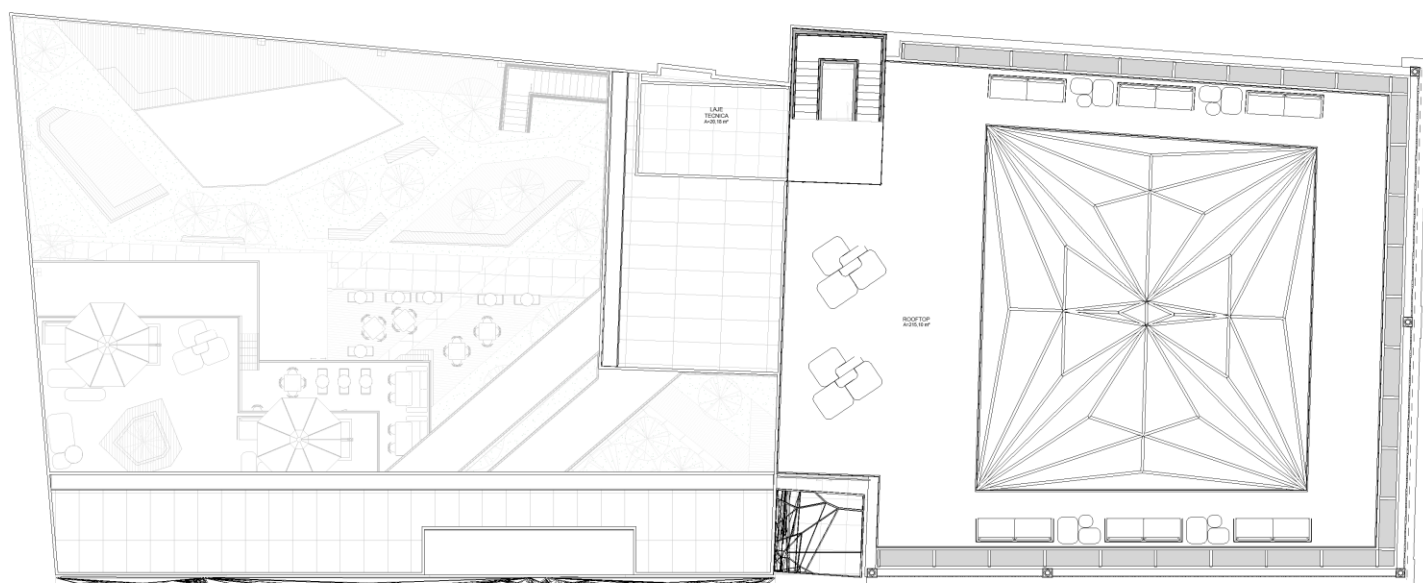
Layout Terraço, Fonte: Autorial, 2023
